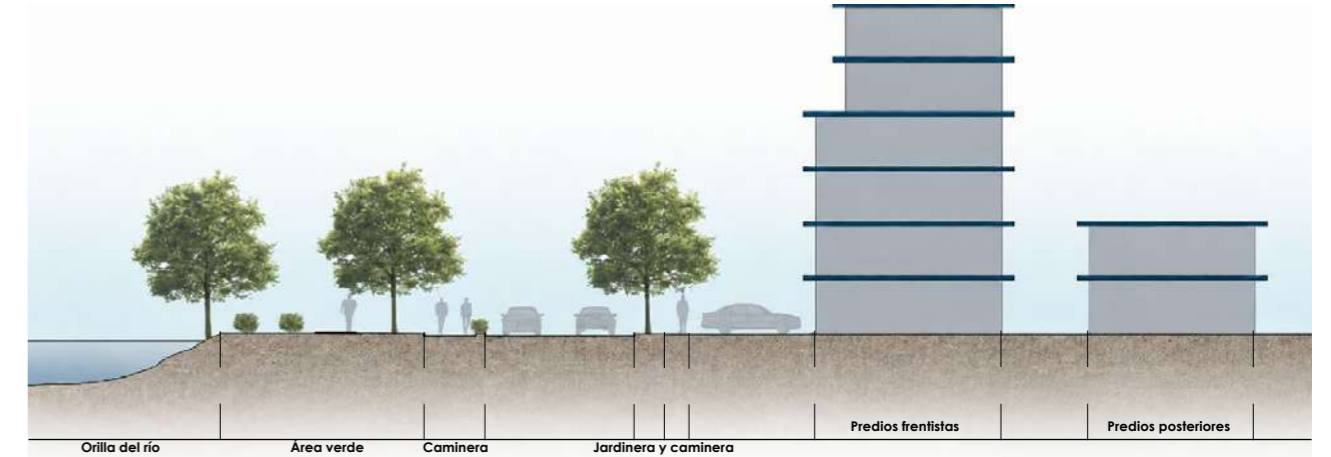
Sección vial Av. 1ro de Mayo. Fuente: Autoría propia.
